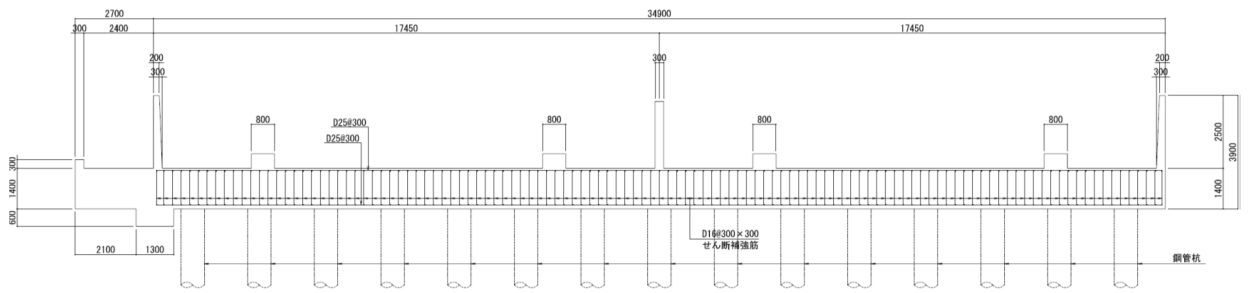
(2) 軽油タンク基礎の断面図 (B-B 断面)
